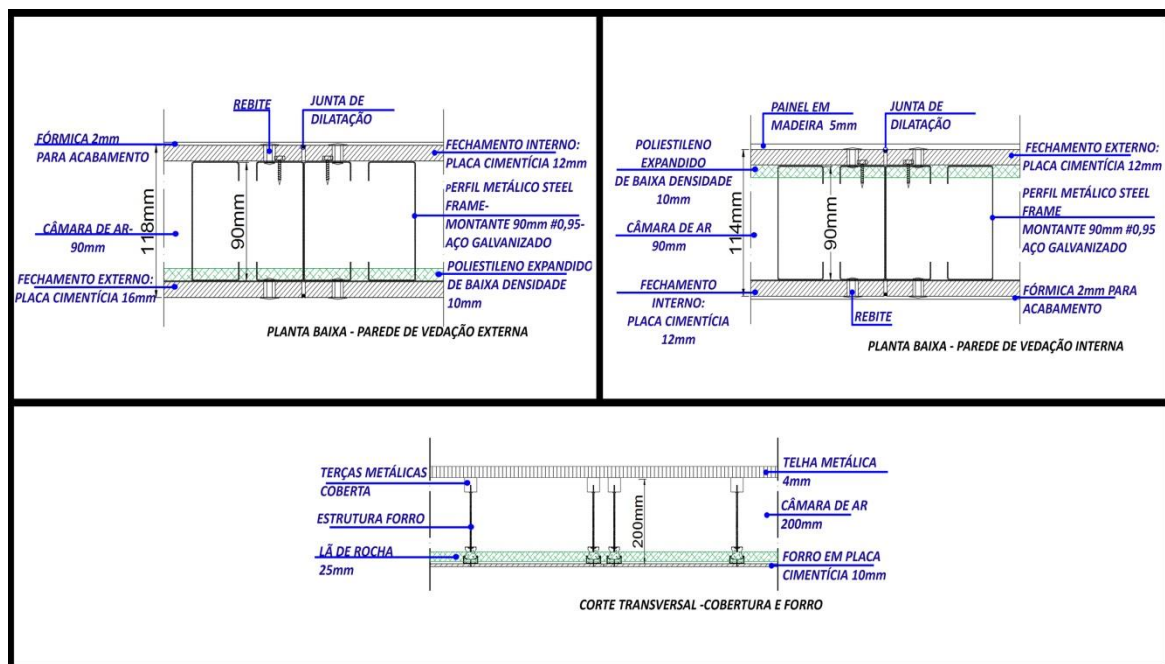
Esquemas do sistema construtivo do objeto de estudo: da parede externa (PE- planta baixa) - 118mm, da parede interna (PI- planta baixa) - 114mm, e da cobertura (corte transversal), respectivamente.
